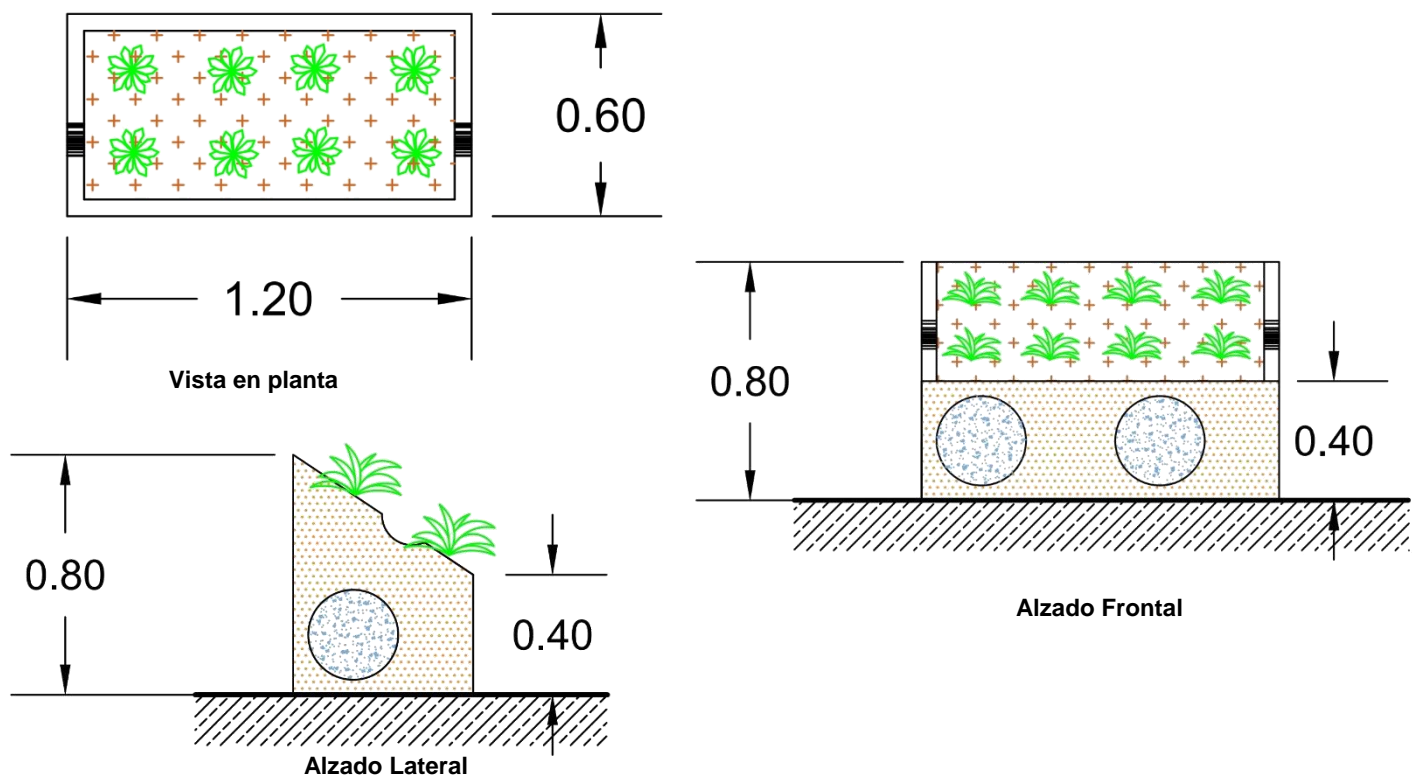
Vistas en planta y alzados de la propuesta del módulo agrícola urbano.
